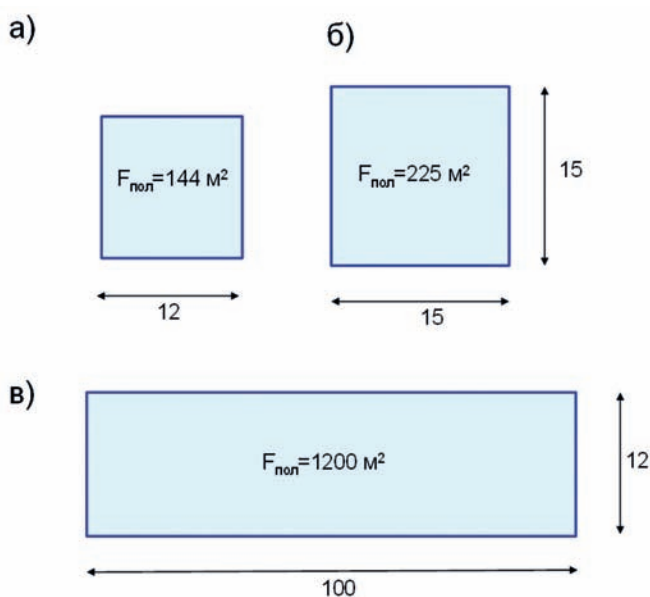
Планы объёмно-планировочных решений гладкостенных форм зданий: а) здание квадратной формы; б) широкоформатное здание; в) здание в виде параллелепипеда
